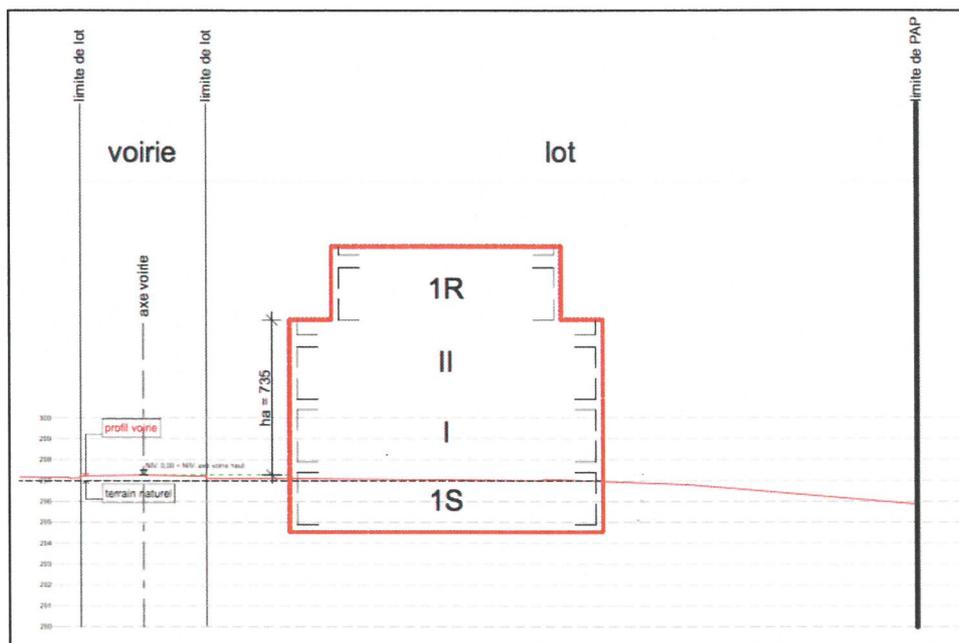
Croquis explicatif pour la définition de la hauteur à l'acrotère
